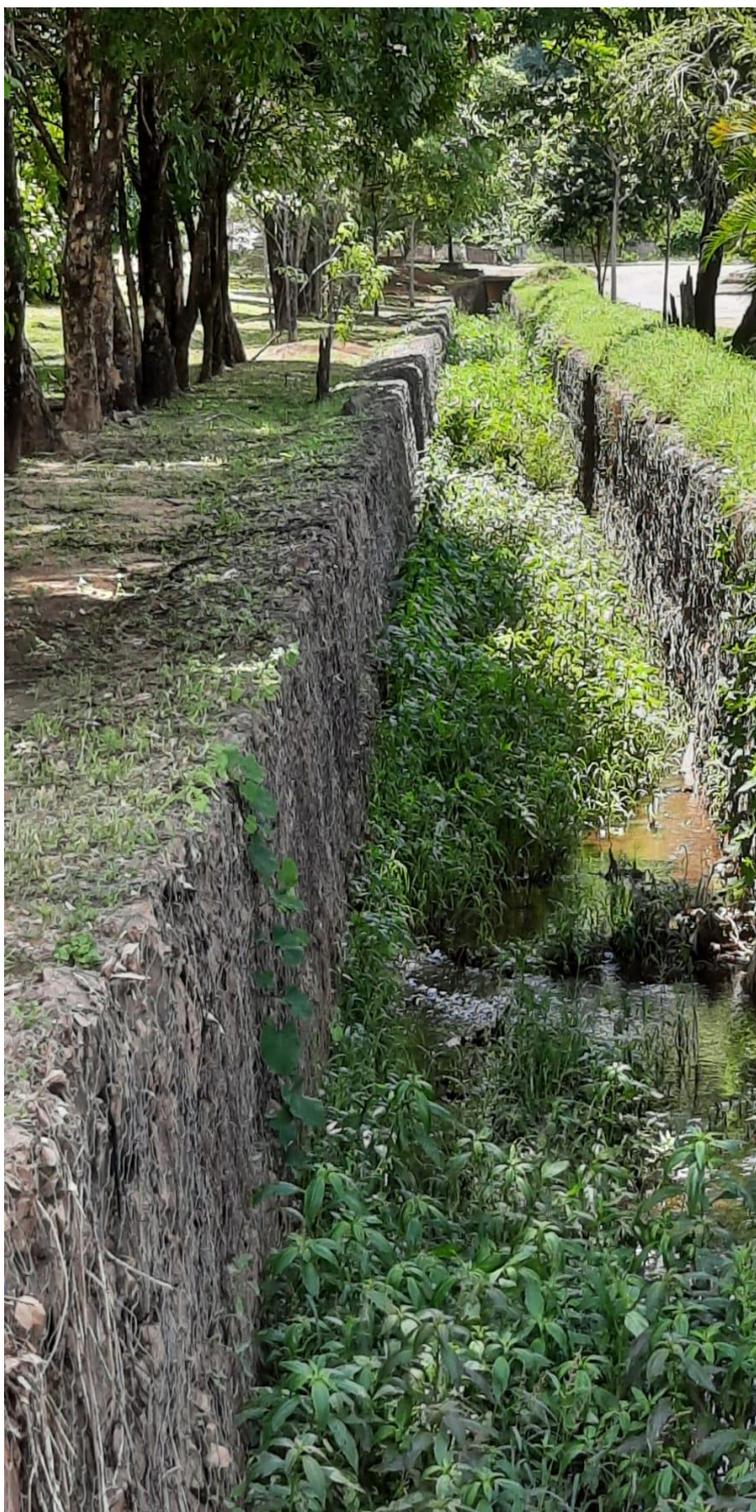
Córrego Jatobá - Local de Estudo e Análise – Piranhas-GO.
